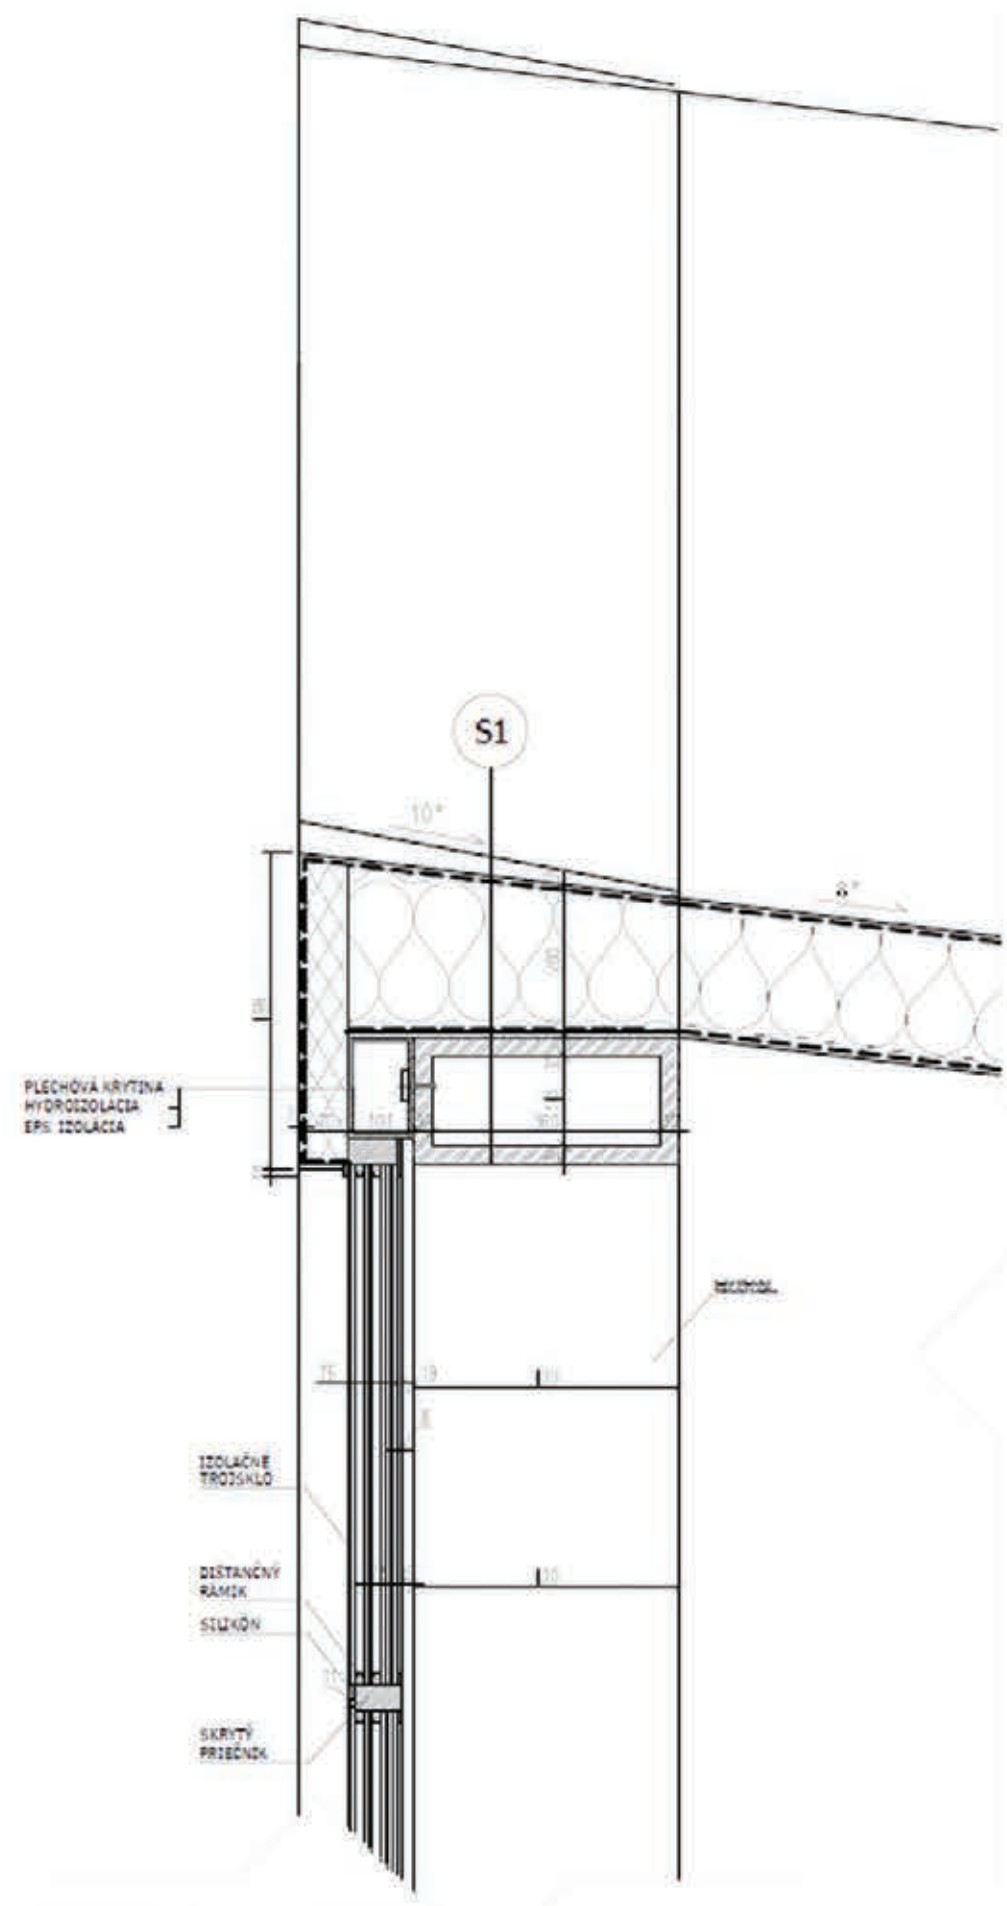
// ROTUNDA_PKO BANKA / VARŠAVA, POĽSKO
